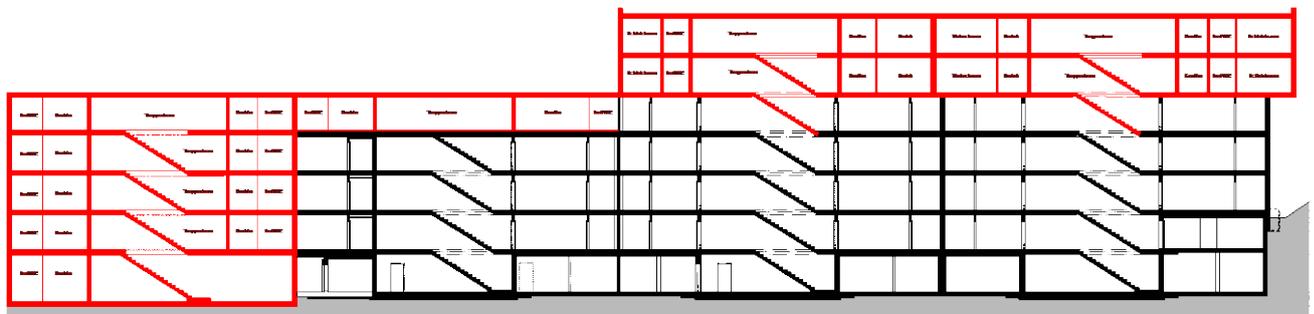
Gebäude B – Längsschnitt [Burkhalter Architekten AG]
